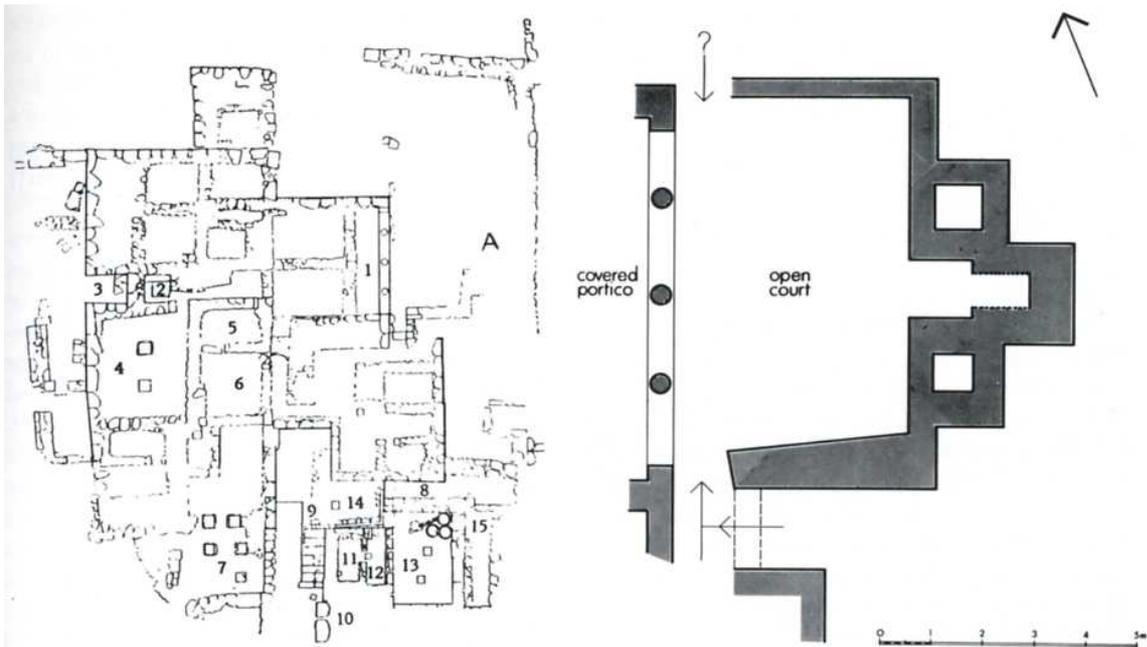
Grundrissplan von Vathypetro nach J. Shaw.
